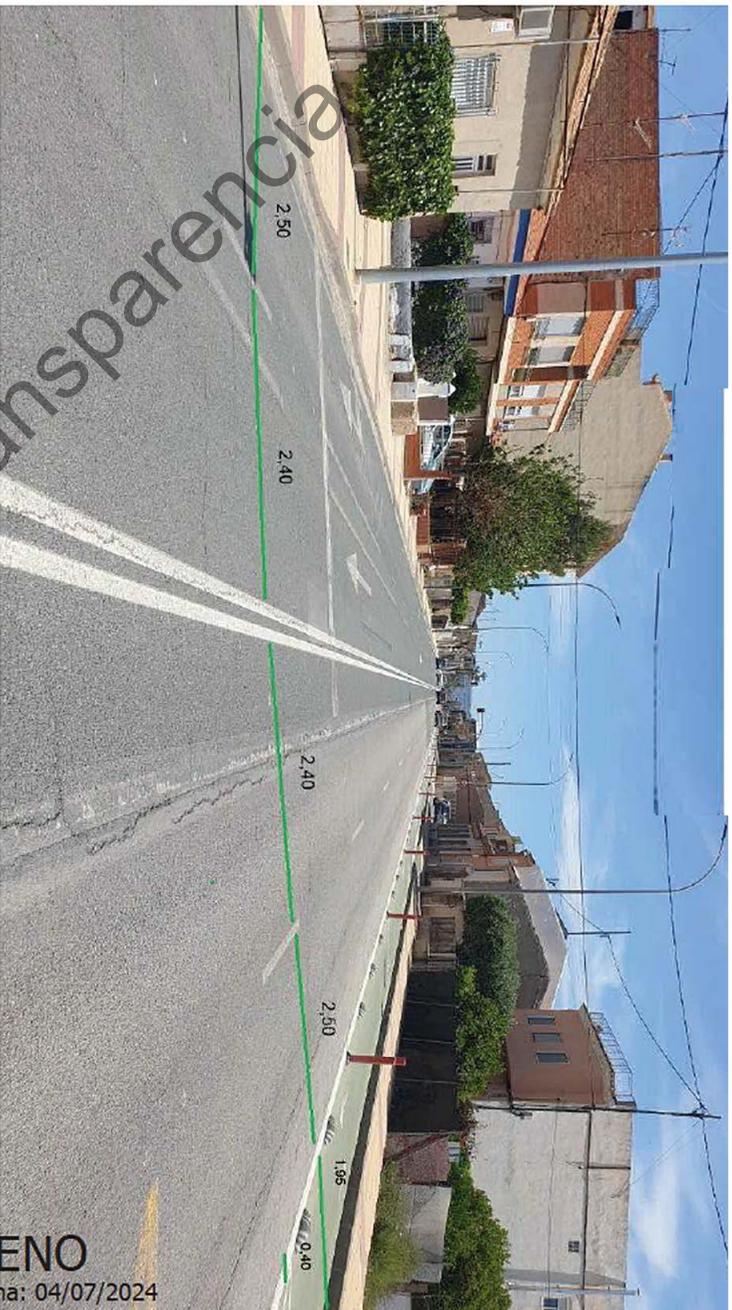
MEDIDAS DE LA CARRETERA DE ALCANTARILLA A MURCIA
